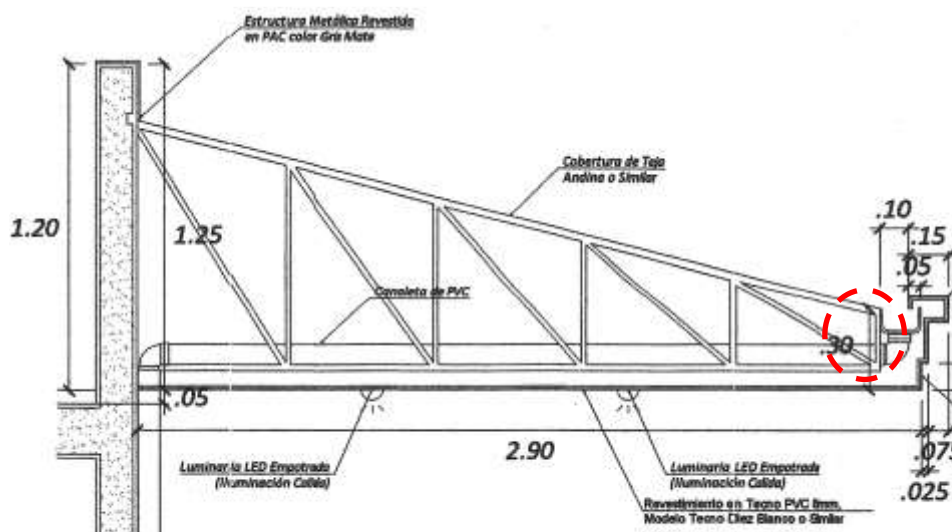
Corte del techo-cobertura, canaleta, friso y parapeto exterior.
